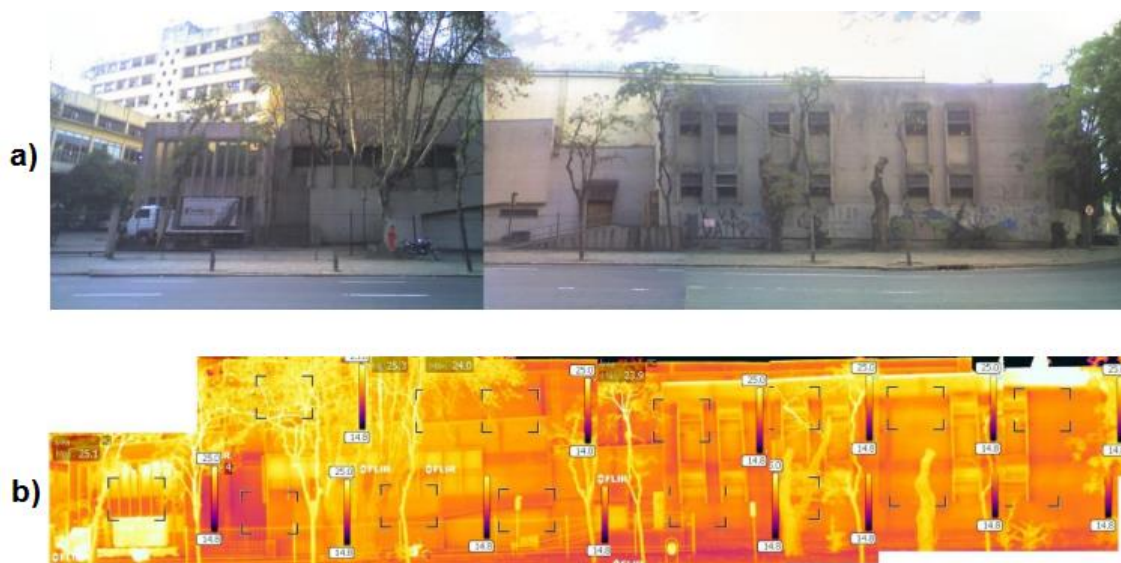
Levantamento visual da fachada sul. b) Levantamento termográfico da fachada sul.
